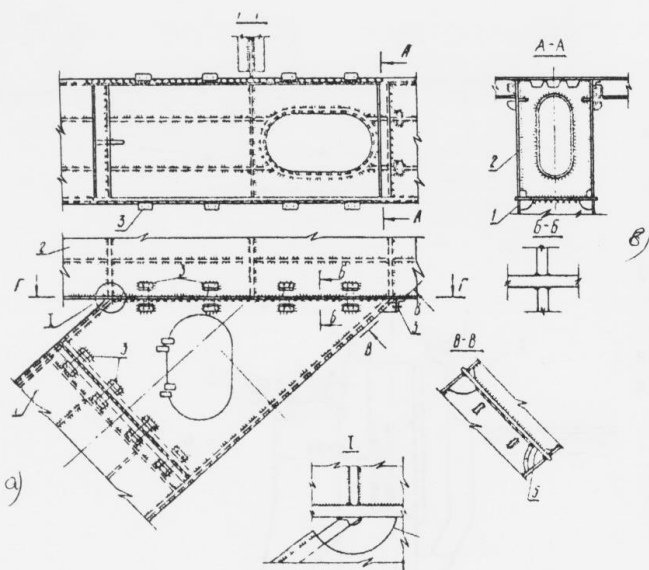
Raccordement des béquilles inclinées au caisson de la poutre principale: a) vue en face; b) coupe transversale; 1 - le caisson de la béquille inclinée; 2 - le caisson de la poutre principale; 3 - les cornières de fixage; 4 - le diaphragme en tôle.
